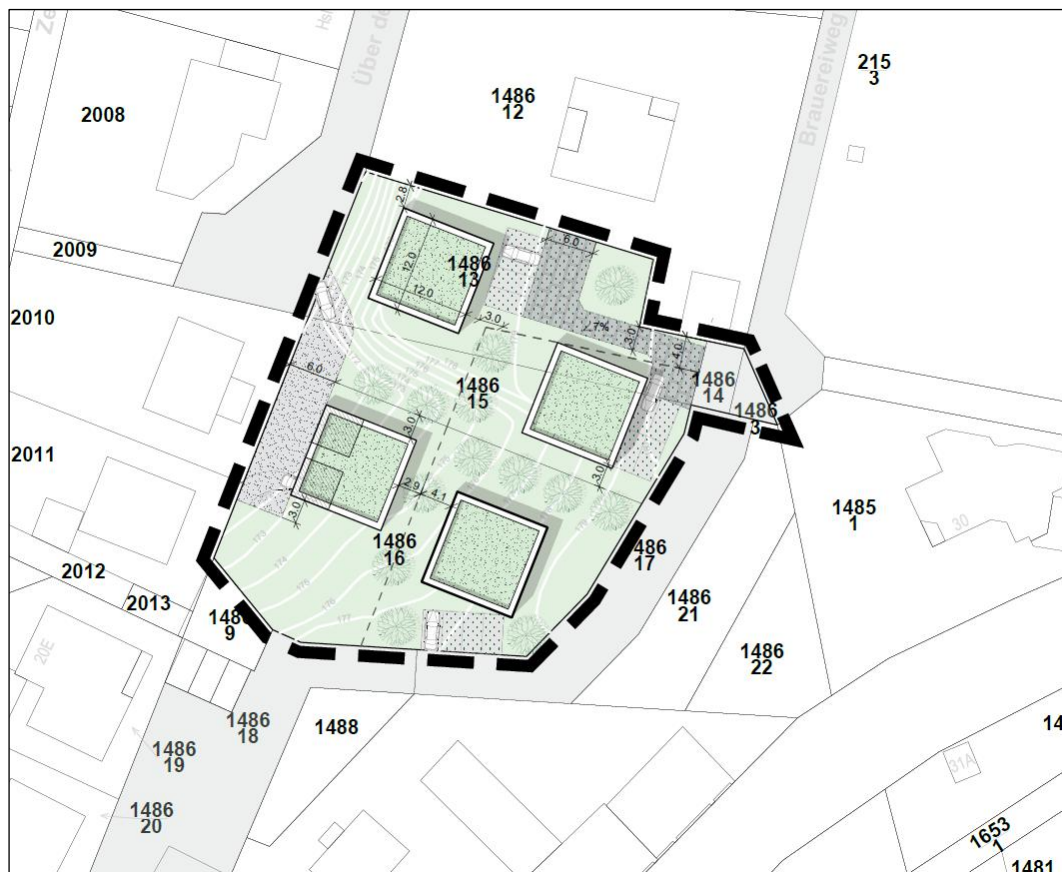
Lageplan des städtebaulichen Konzepts (Quelle: Planungsgruppe Darmstadt, Stand: Januar 2026)
